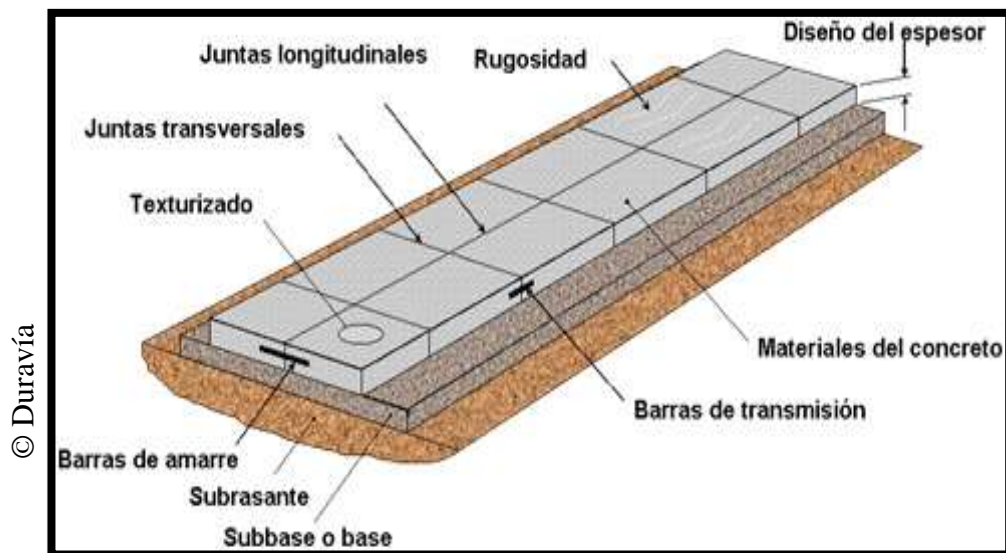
Pavimento de concreto simple con juntas longitudinales y transversales
